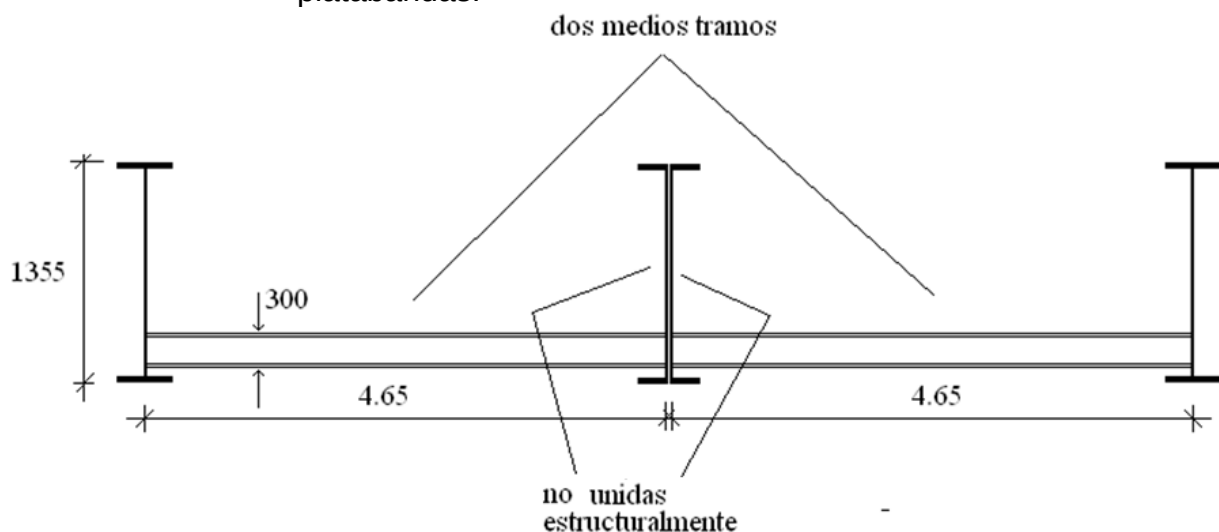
Corte transversal, esquemático, de la nueva estructura del puente.
